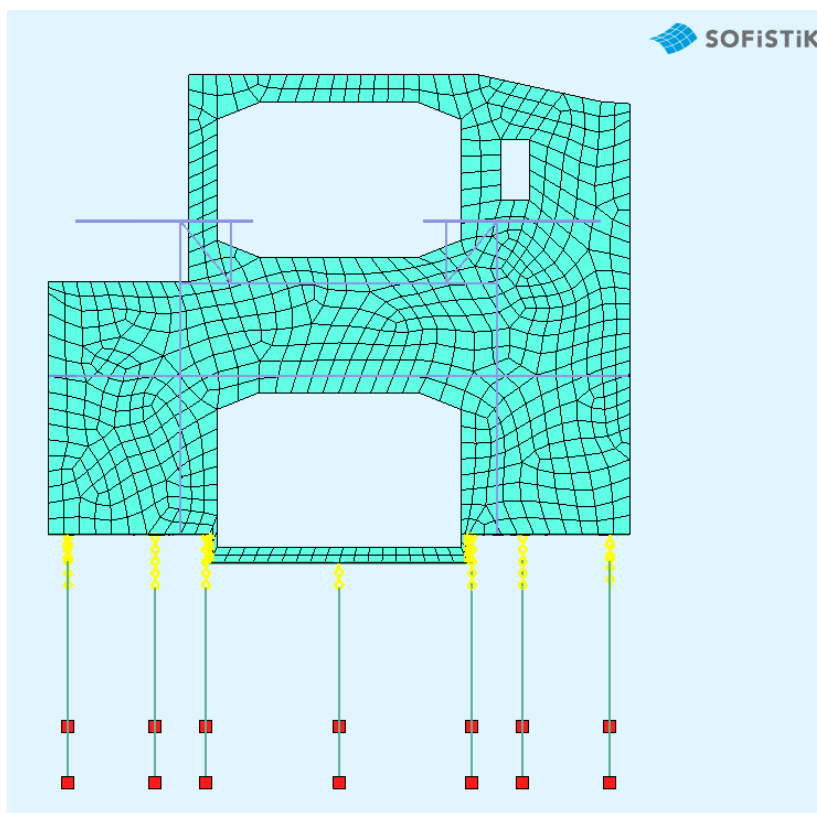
Alçado Poente do modelo de cálculo da estação – fachada Poente EAL + laje de fundação e estacas
